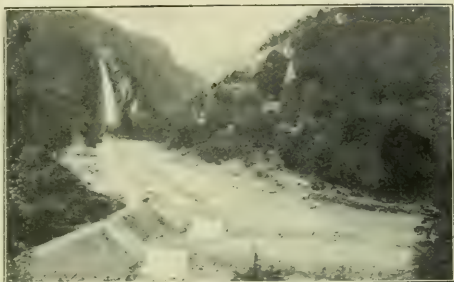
RECTIFICATION ET FIXATION DU LIT D'UN TORRENT.
